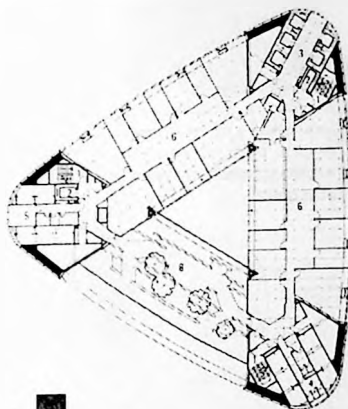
Planta baixa do pavimento tipo de escritórios, destaque para a distribuição entre área útil de ocupação e as áreas de jardim. Fonte: DAVIS, 1997.
